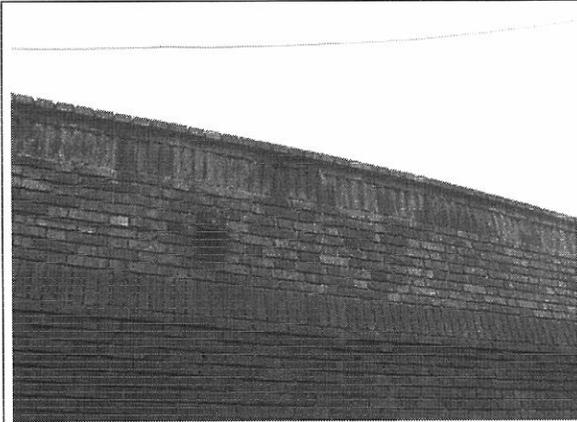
Agrietamiento y deformación del muro de fachada.
